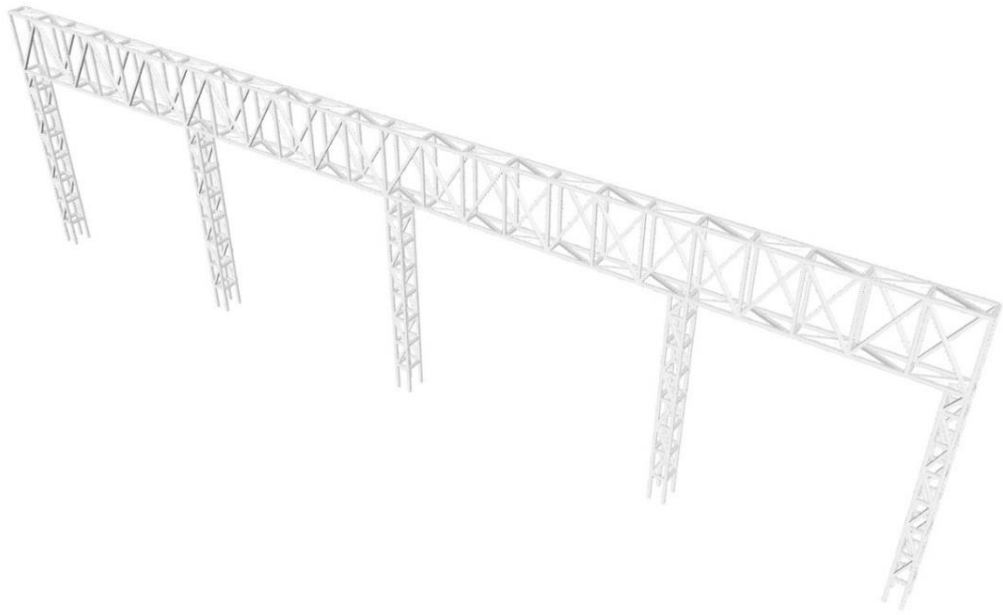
| *Pórtico 1, tipo 2 - extremo -, de la estructura resistente
